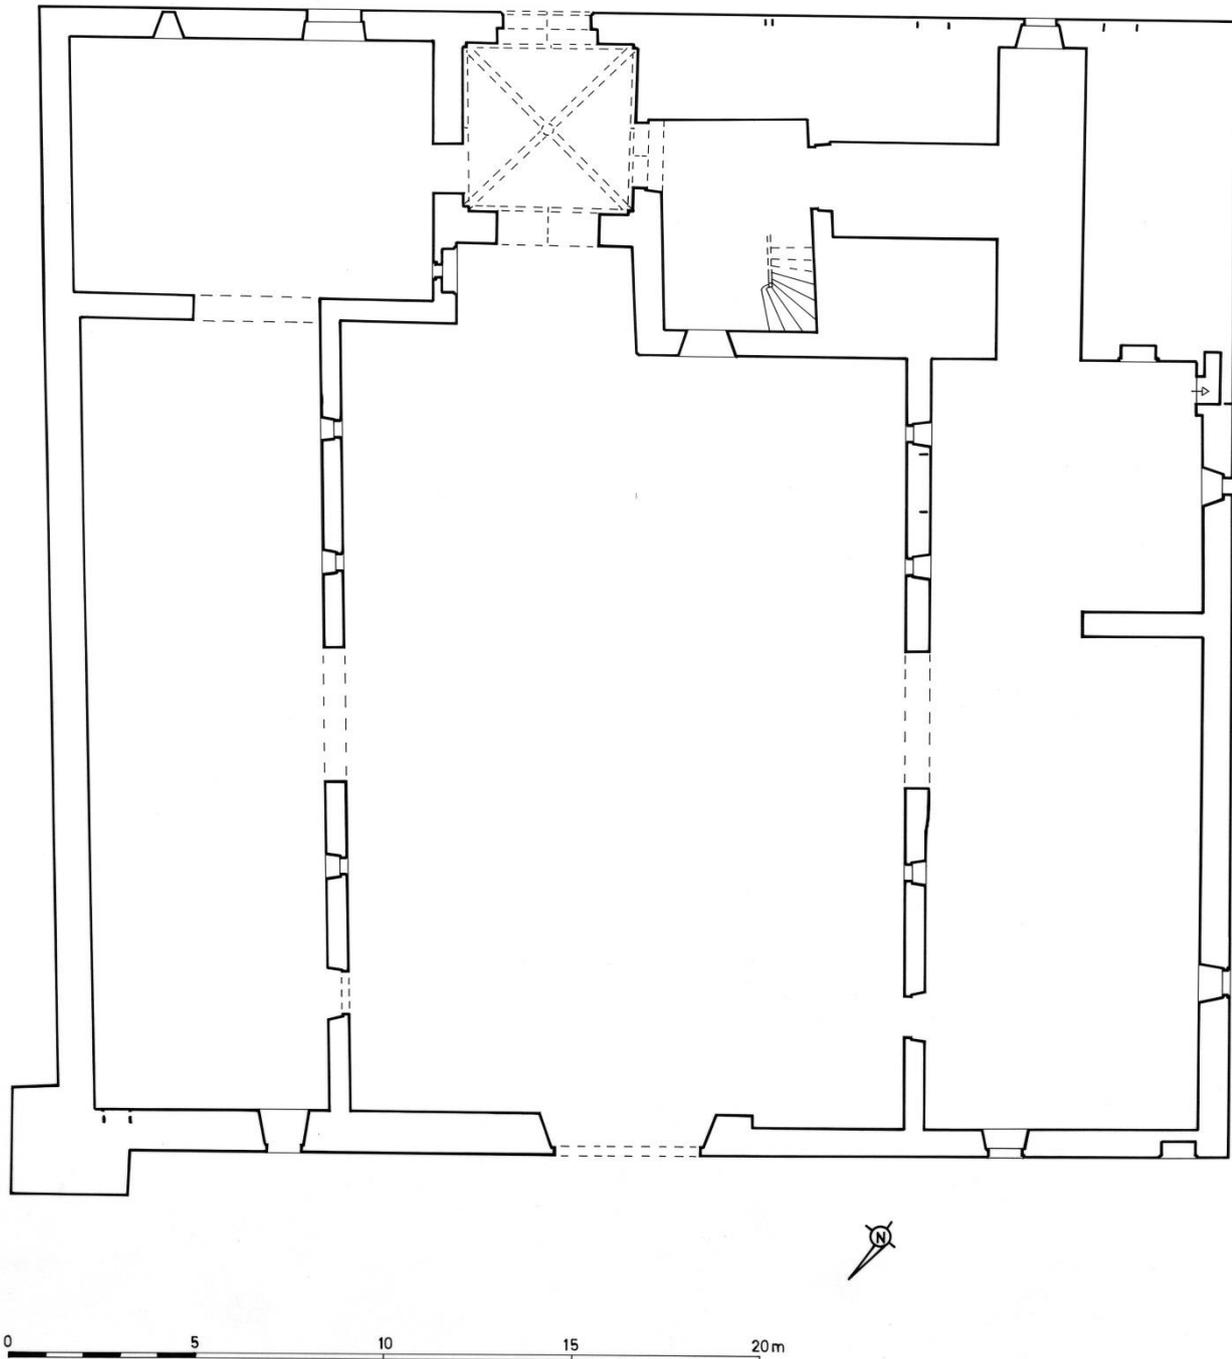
Relevé du plan du château par Patrick Roques (1997) : rez-de-chaussée.
